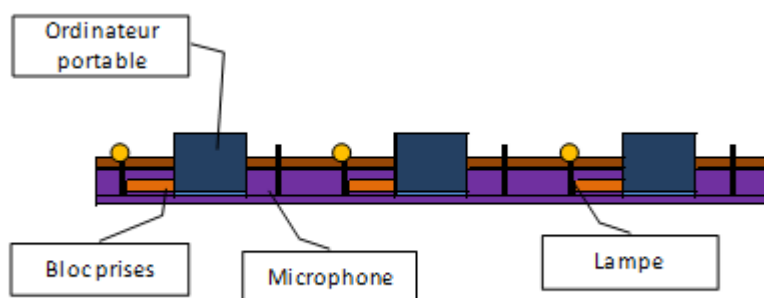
Coupe transversale, positionnement des écrans – Salles pénales et salles civiles
